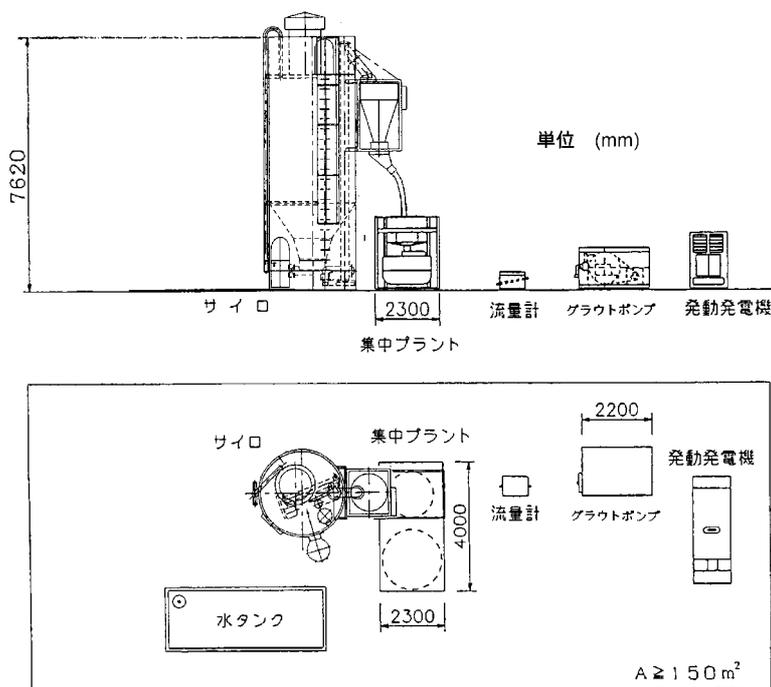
標準的な固化処理プラントの施工機械・設備の配置例
